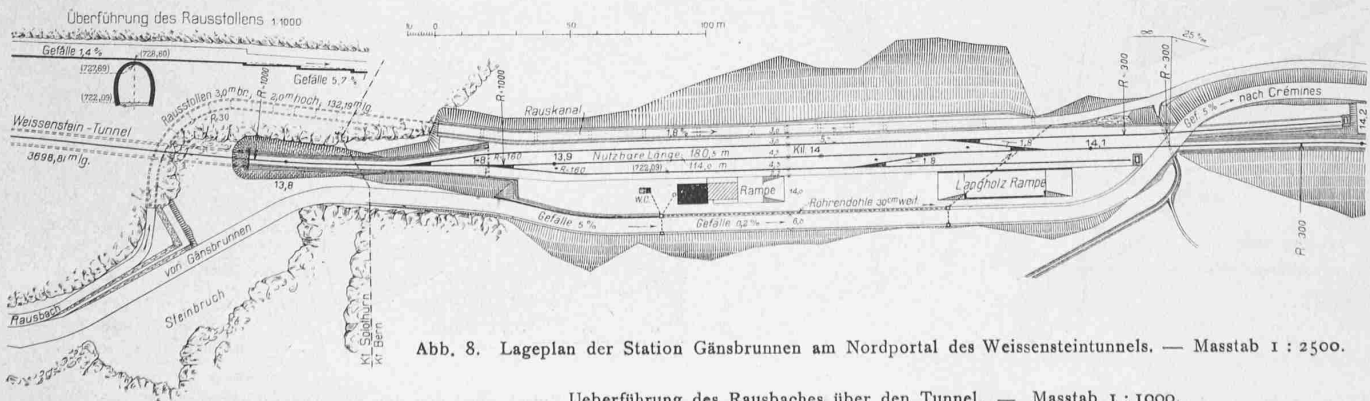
Lageplan der Station Gännsbrunn am Nordportal des Weissensteintunnels. — Masstab 1 : 2500.
